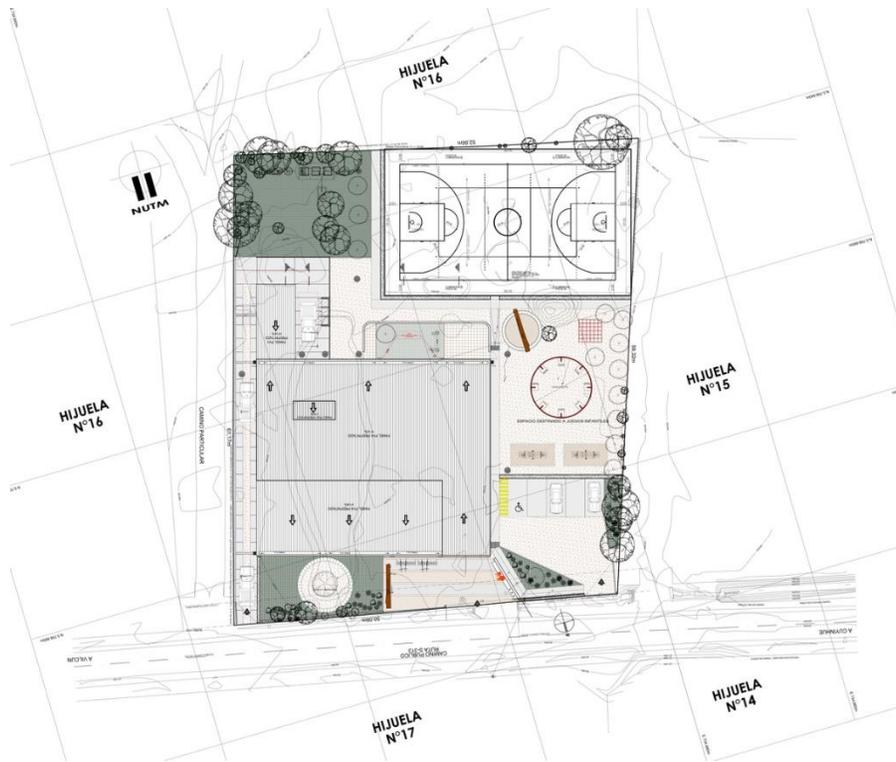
Planta Conjunto Escuela Basica Cantino. Fuente:
